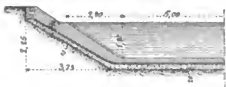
Dichtung mit Tonschlag. M. 1 : 200.
